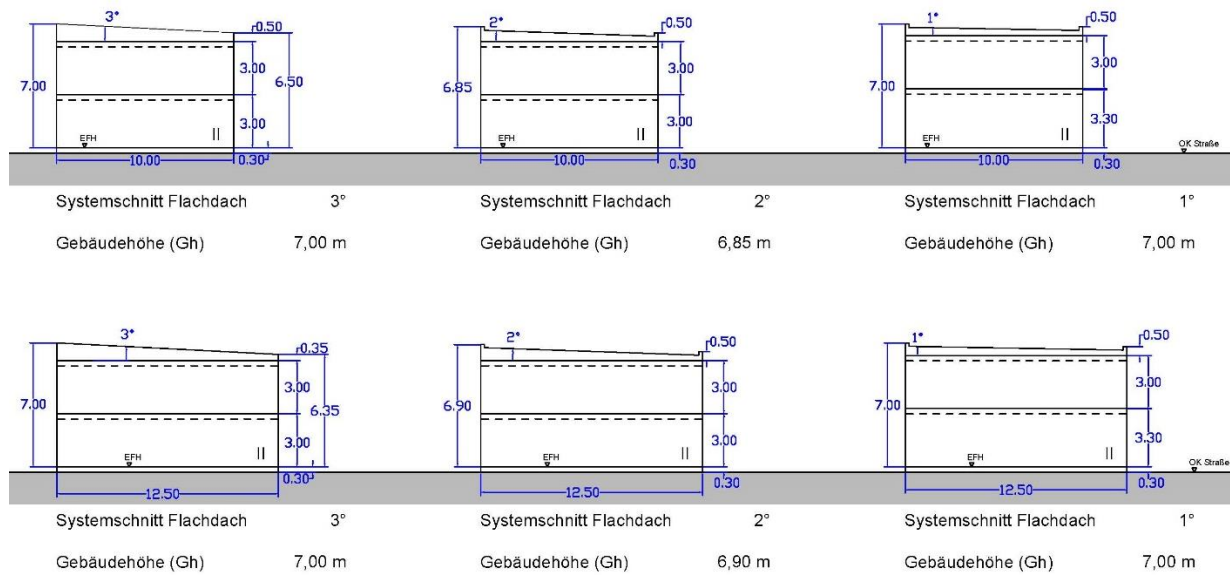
Systemschnitte Gebäude mit Flachdach (Gh 7,0 m, DN 0°-8°), Stand 17.08.2015, ohne Maßstab
